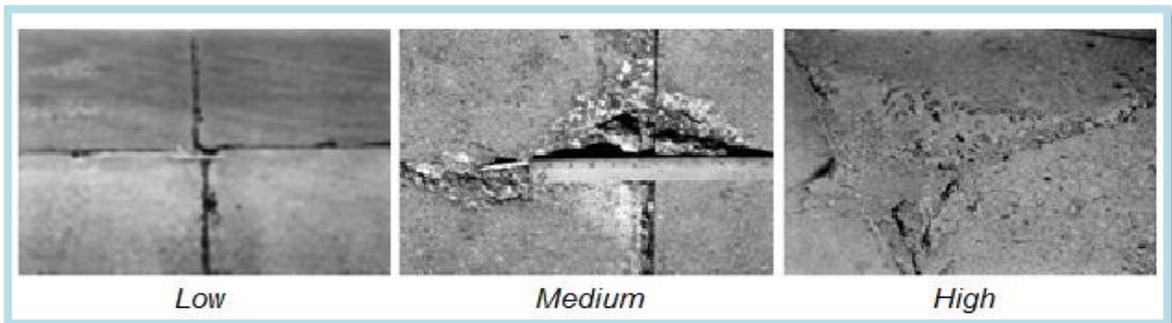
Tingkat kerusakan Slab Retak Susut (*Shrinkage Cracks*)
